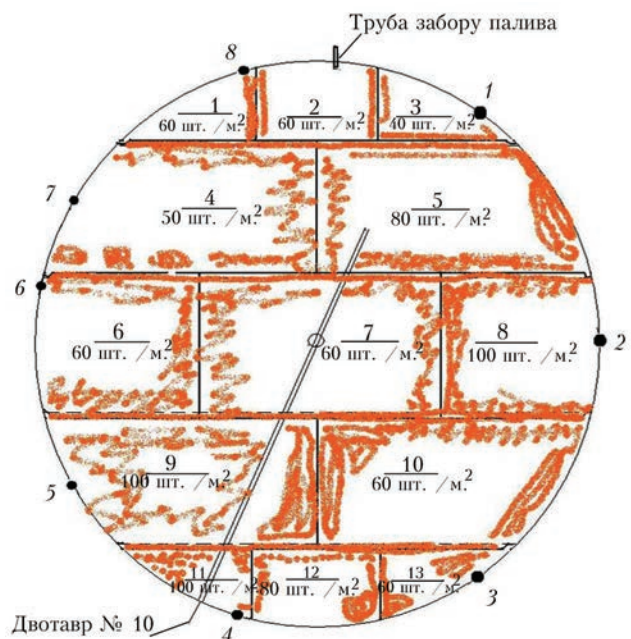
Схема корозійних пошкоджень днища внутрішнього резервуара
